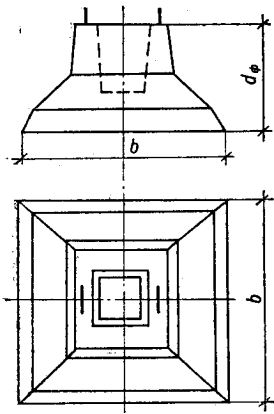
Збірний залізобетонний фундамент за ГОСТ 24476—80
